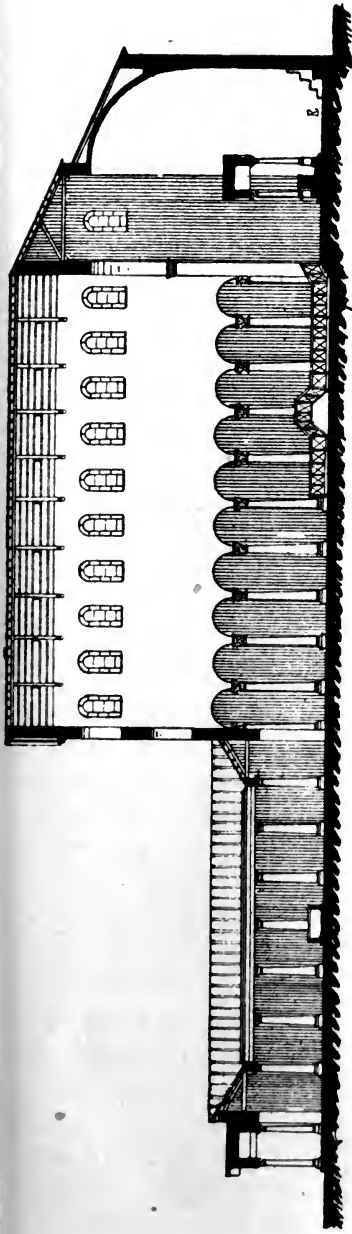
COUPE LONGITUDINALE ET PLAN D'UNE BASILIQUE LATINE. (Dessin de l'auteur.)
